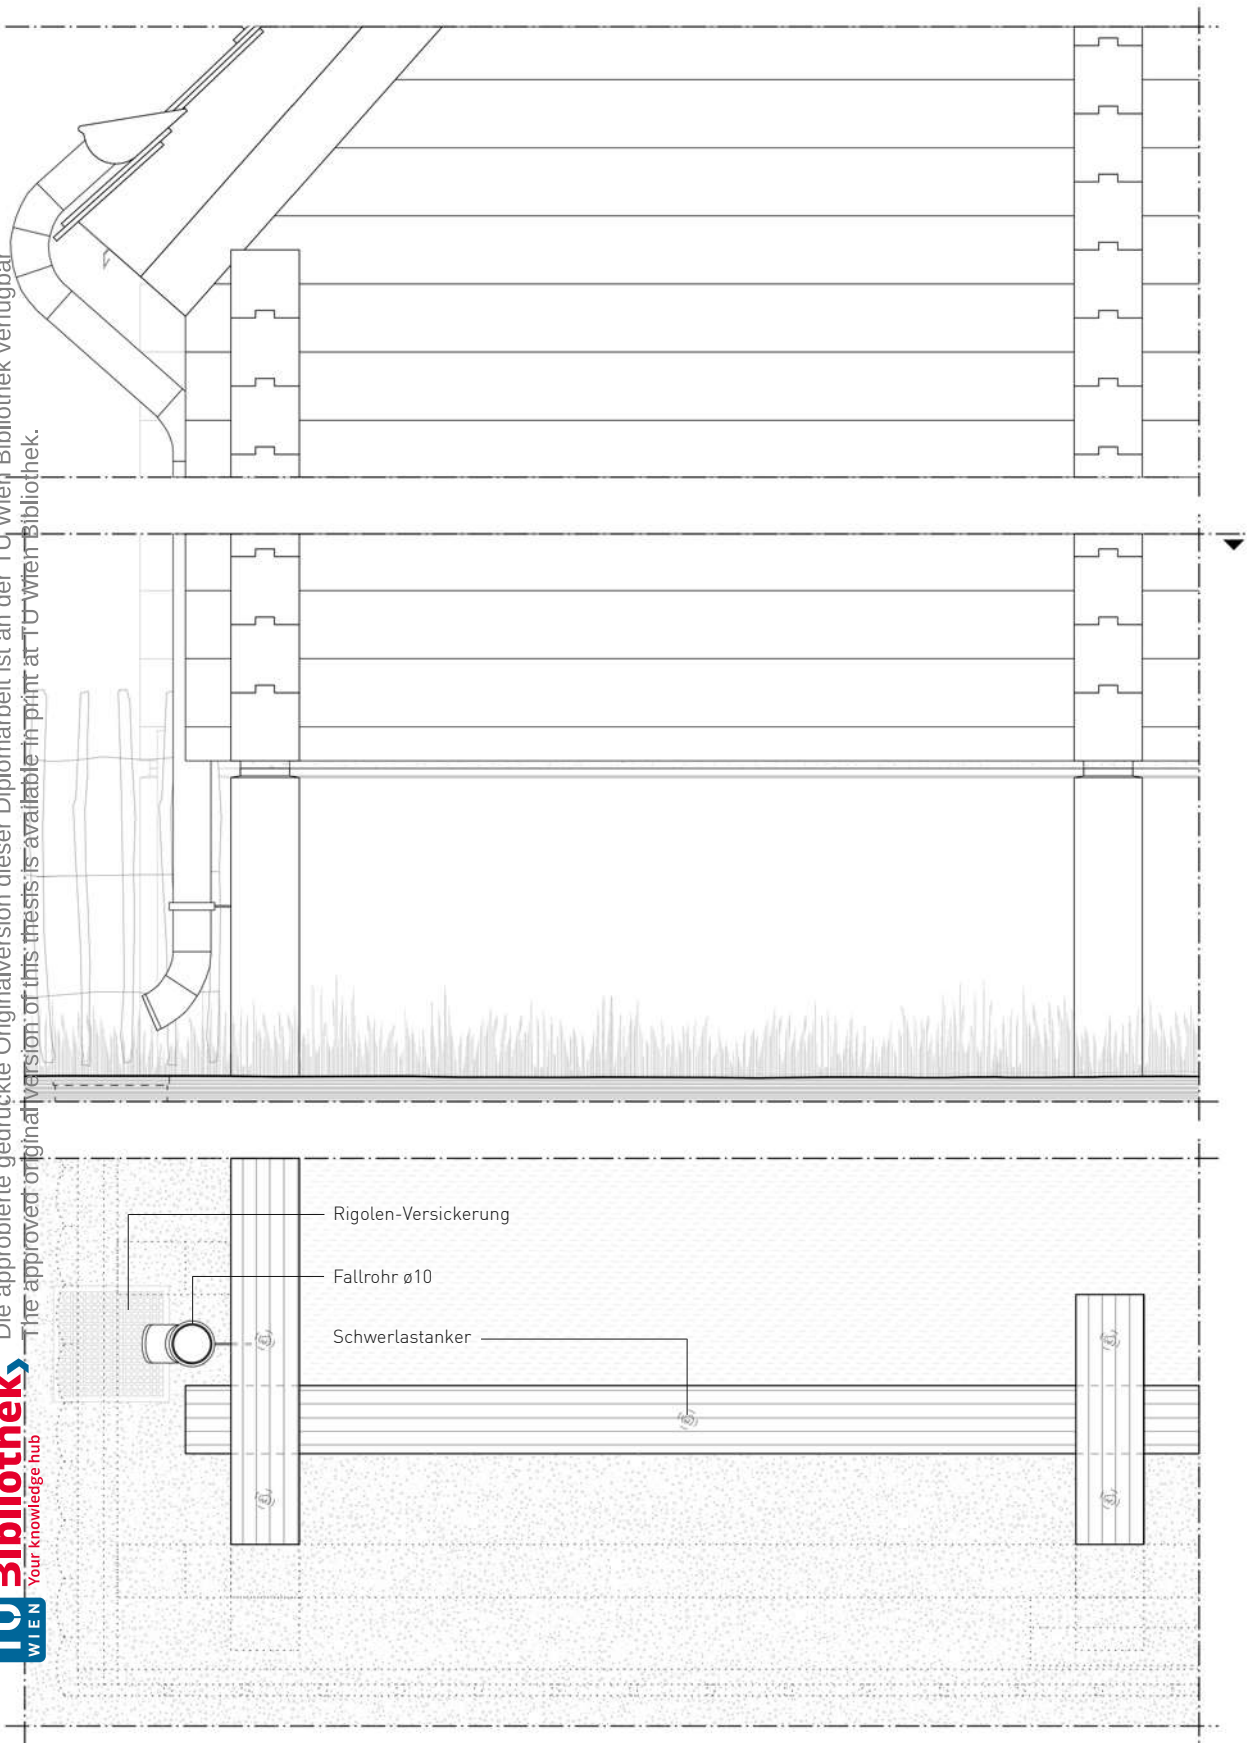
Detailschnitt Giebelwand 1:20
